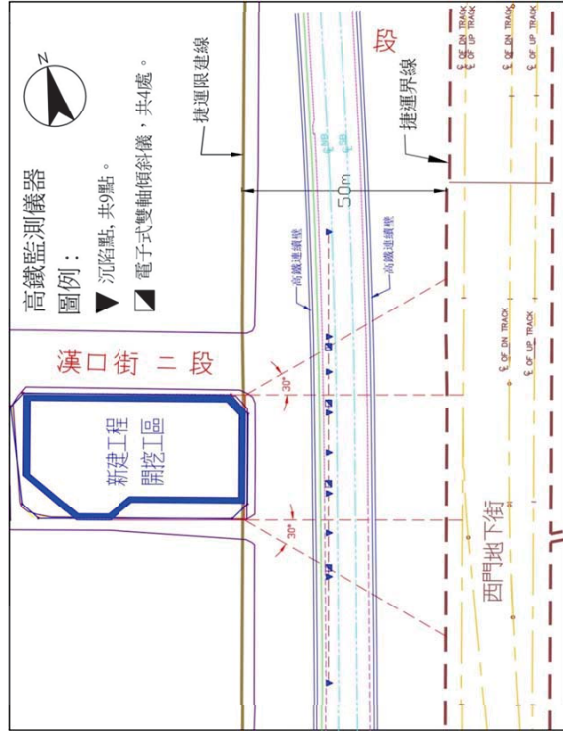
高鐵隧道監測儀器佈設範圍及儀器配置平面示意圖
